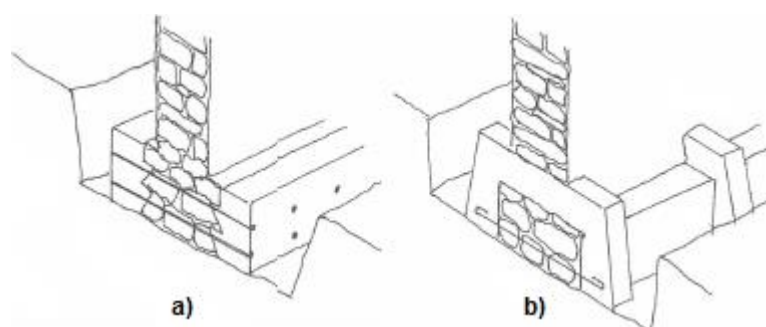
Ligação do alargamento à fundação existente através: a) de varões; b) cinta de betão armado [55]
